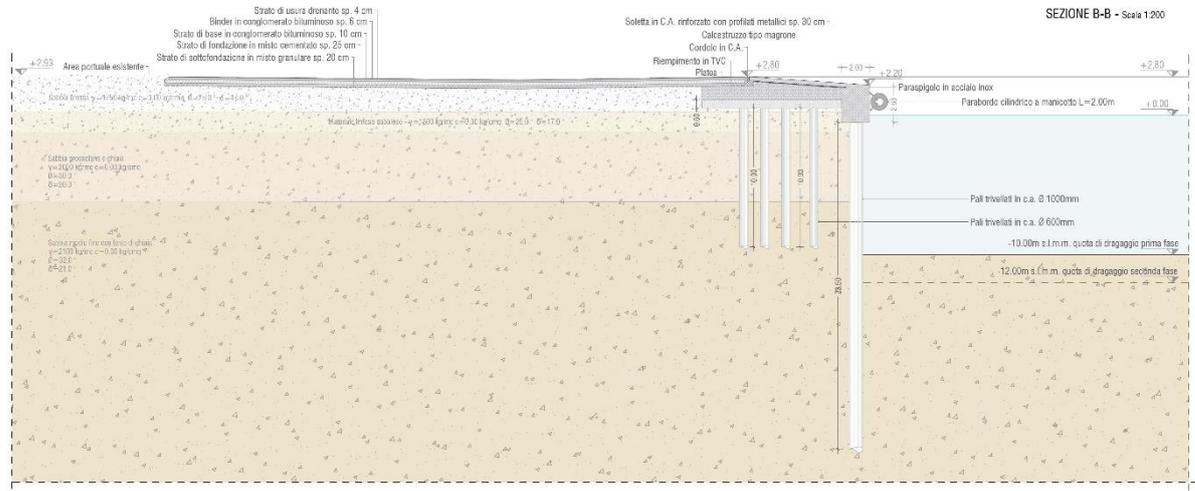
Banchina di progetto -Pianta e sezioni tipo (Elab. EG.09)
